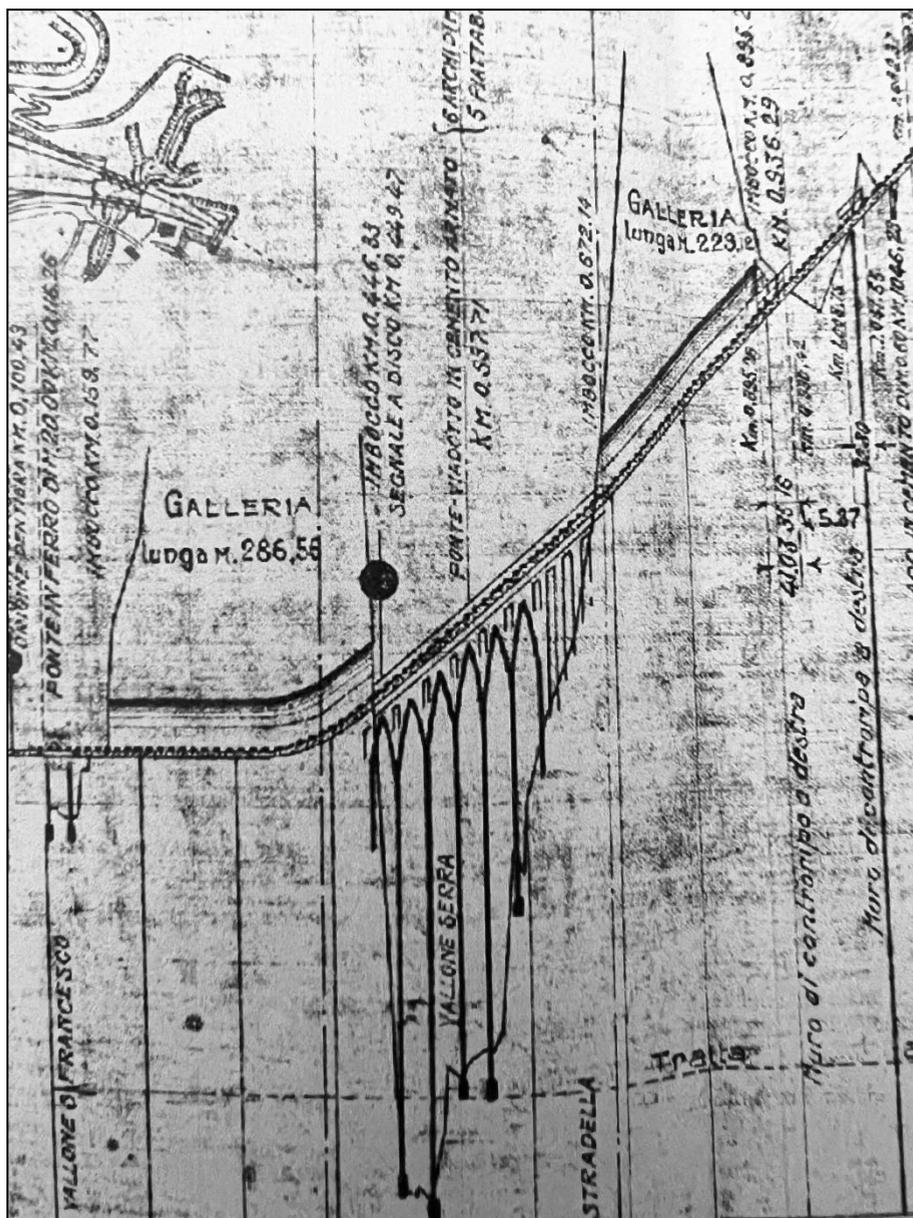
Particolari del Viadotto Serra. Planimetria e profilo di esecuzione. (Fonte: Davide Nesi, 2005).
